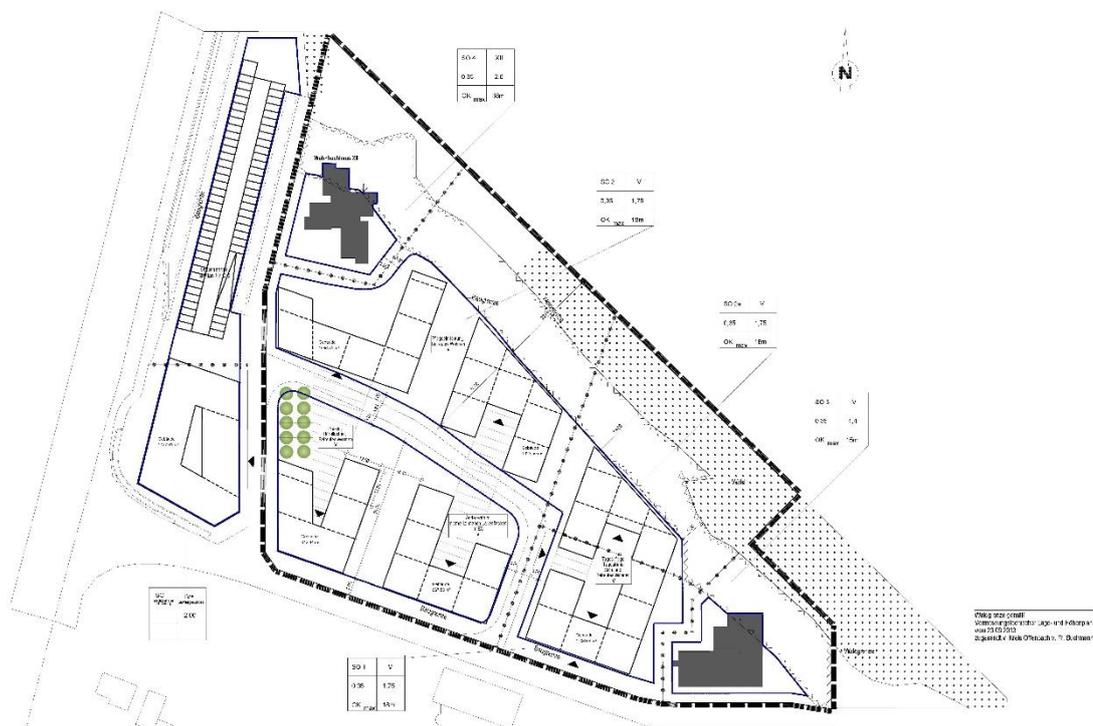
Städtebaulicher Entwurf Medi Park, Architekturbüro Planwerk, 17.12.2020
